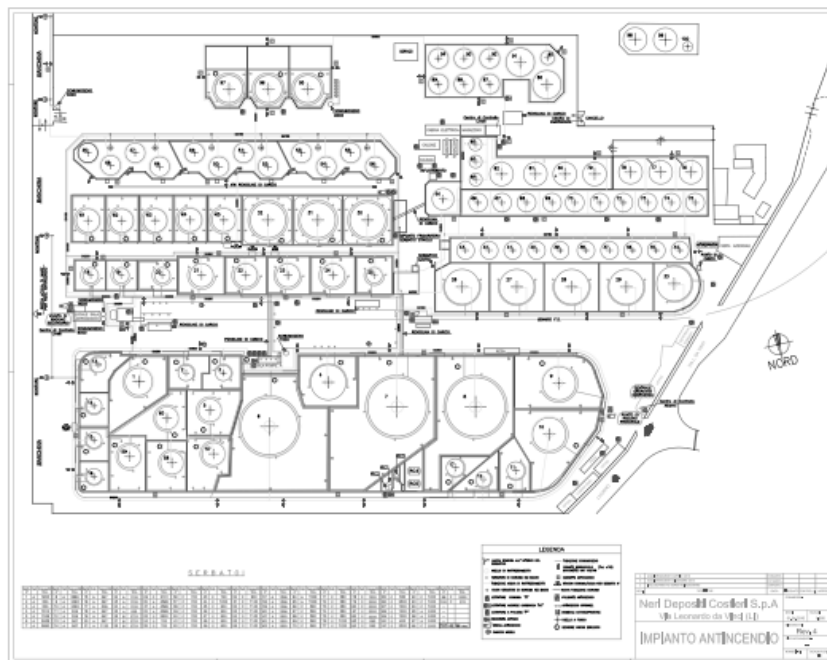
Planimetria di stabilimento tratta dal RdS 2016
